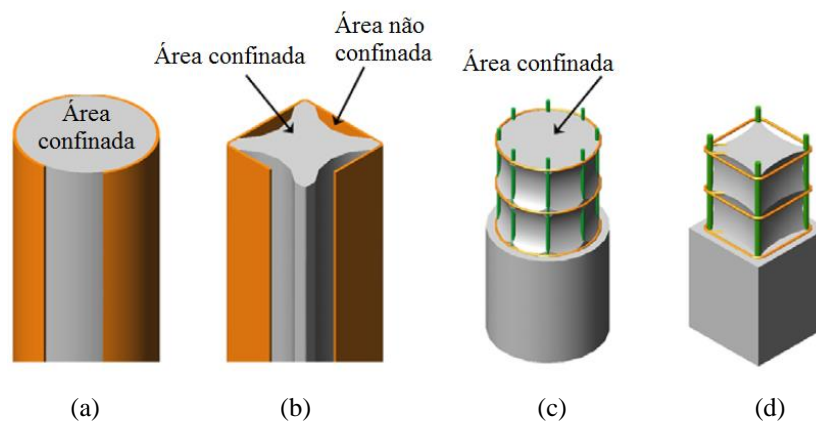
Efeito de confinamento em PMPC e pilares de concreto armado (Oliveira *et al.*,2010): (a) PMPC com seção circular; (b) PMPC com seção retangular; (c) pilar de concreto armado com seção circular; (d) pilar de concreto armado com seção quadrada.
